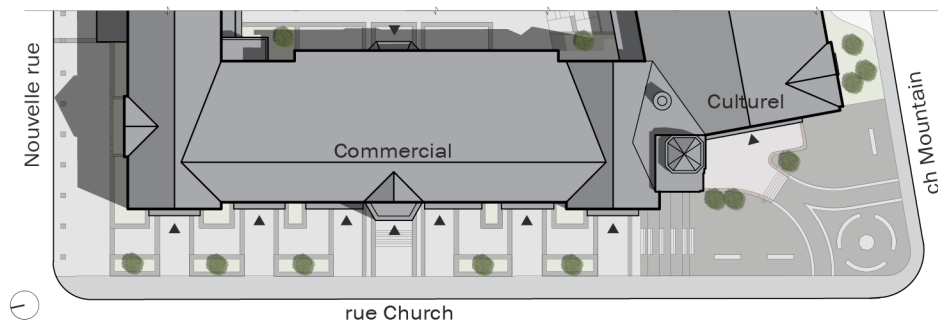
Plan des places publiques sur la rue Church (par l'auteure)
